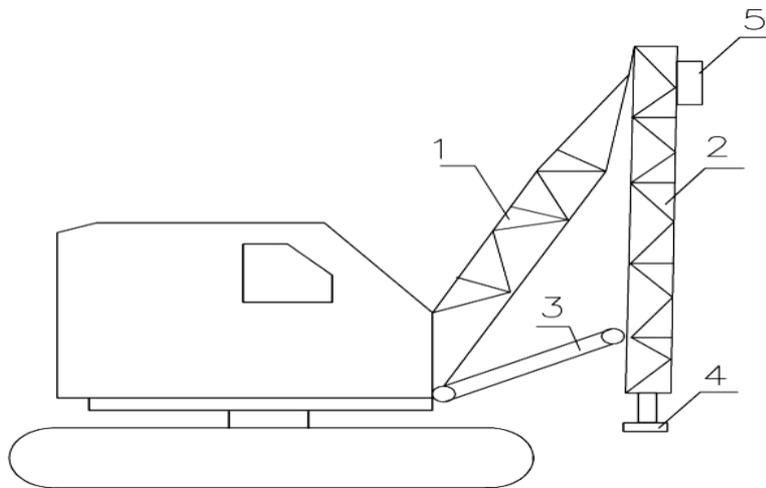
Навесное копровое оборудование на экскаваторе (КО):
